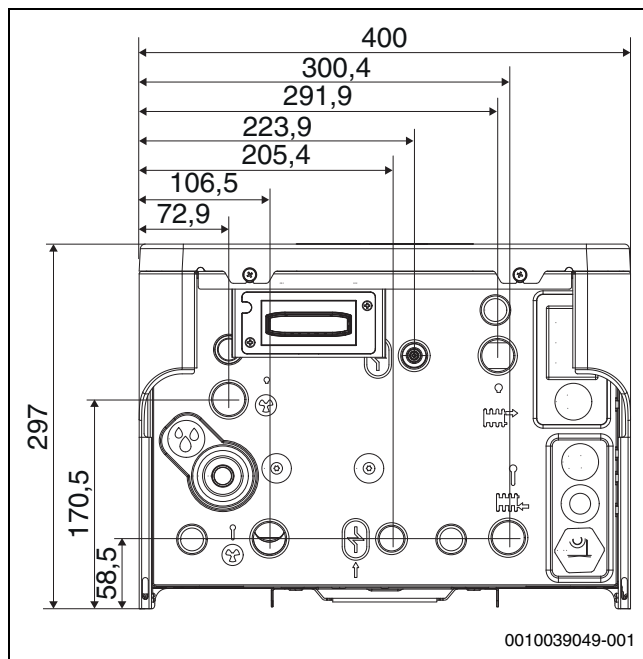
Dimensiuni, racorduri, vedere de jos (mm)
